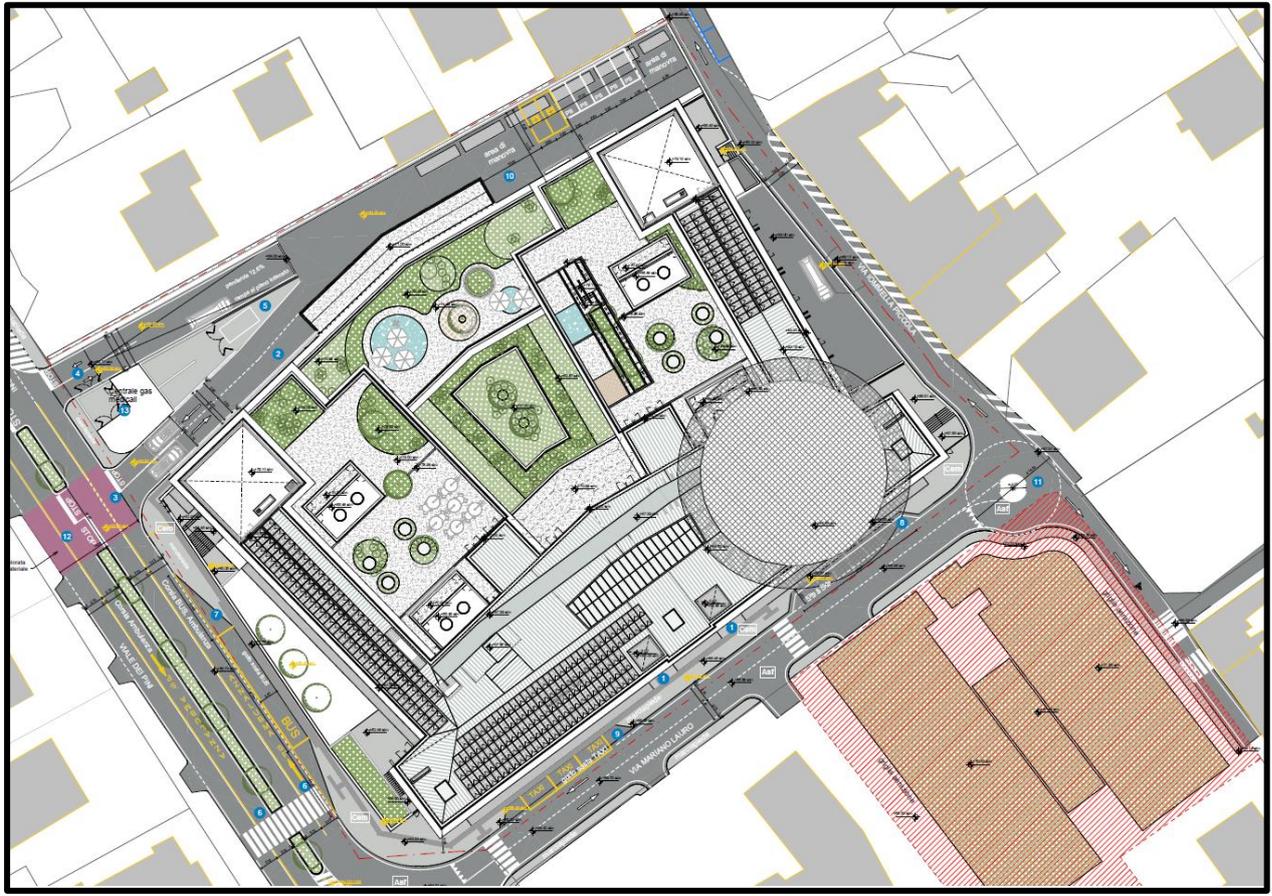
Stralcio della tavola architettonica “Progetto planimetria generale e sistemazioni esterne”
